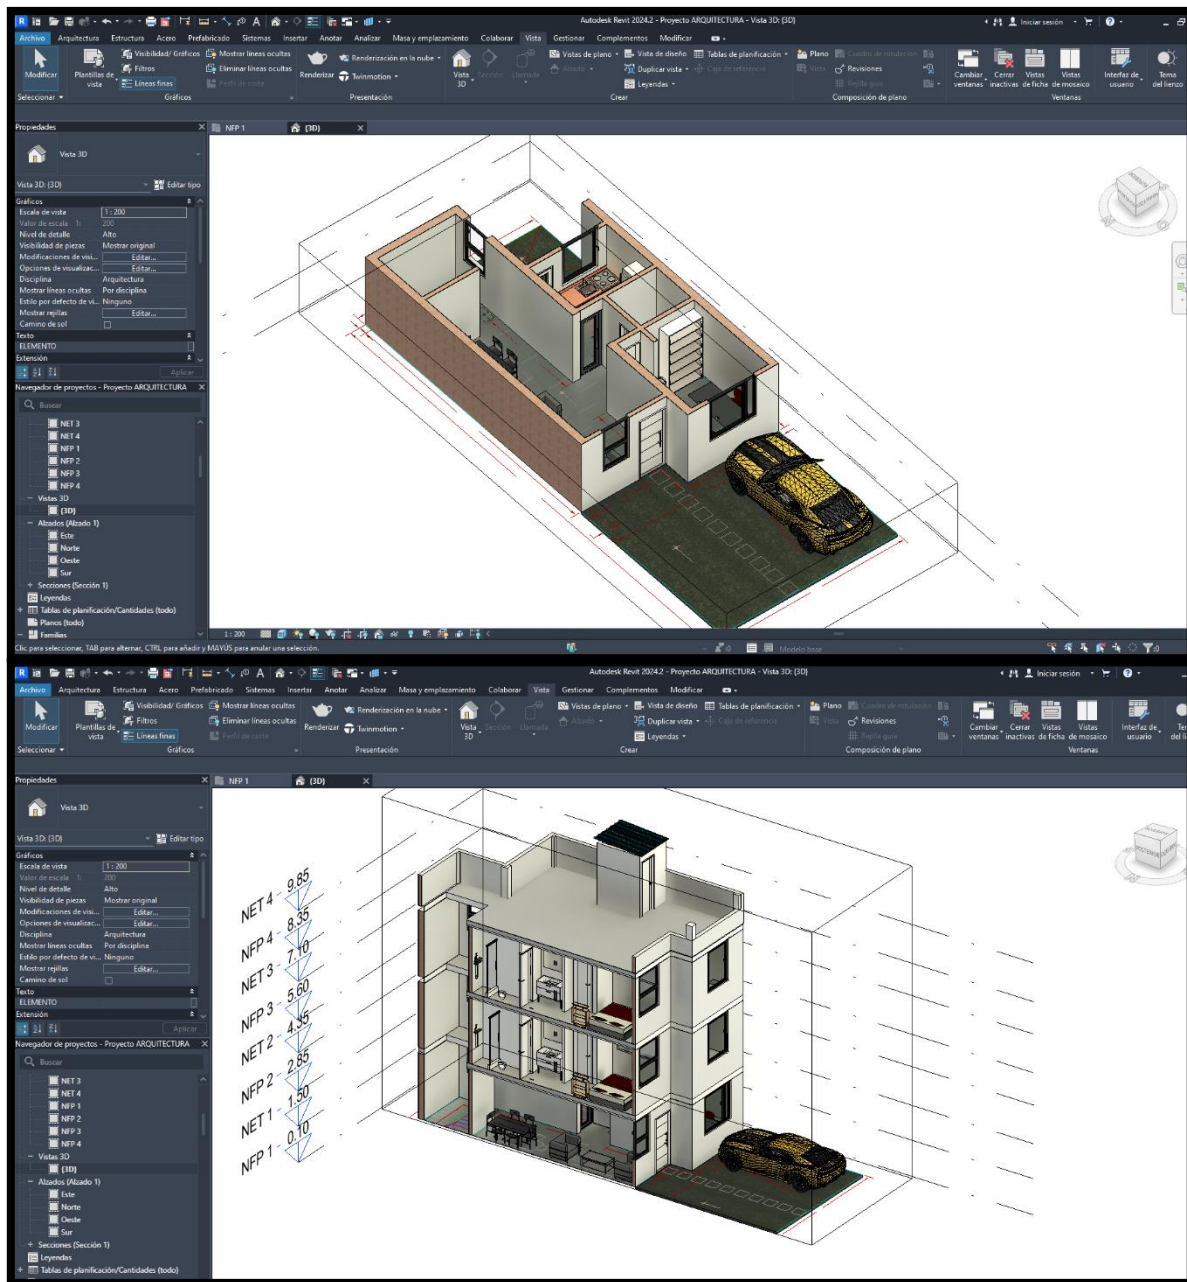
Plano CAD vinculado al Revit para el modelado Arquitectónico
